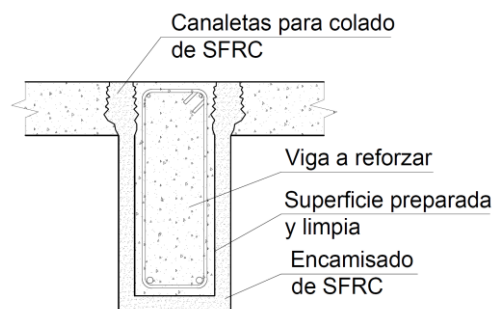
Refuerzo de viga mediante encamisado de SFRC
